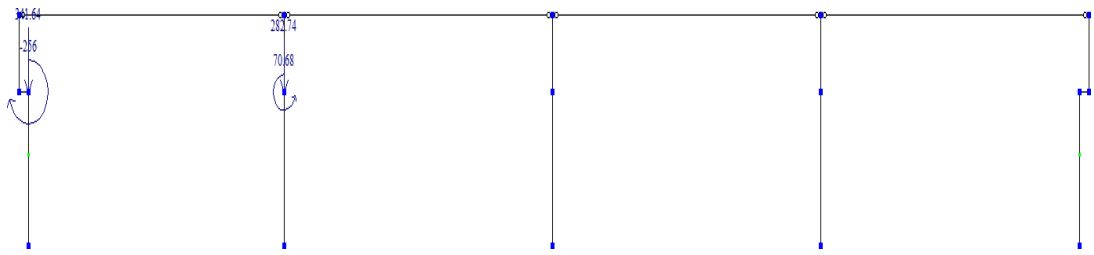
Розрахункова схема будівлі від кранового навантаження по ряду Д (проліт Г-Д)
